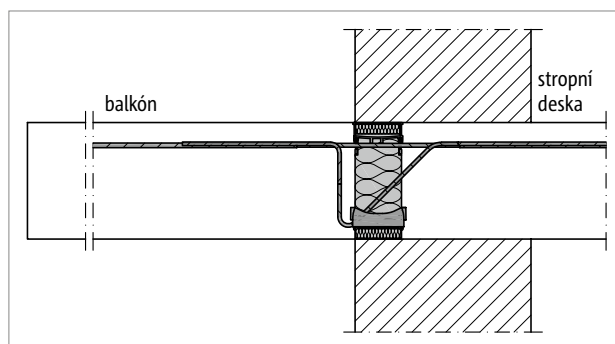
Schöck Isokorb® T typ KL: Balkón na vnějším rohu
